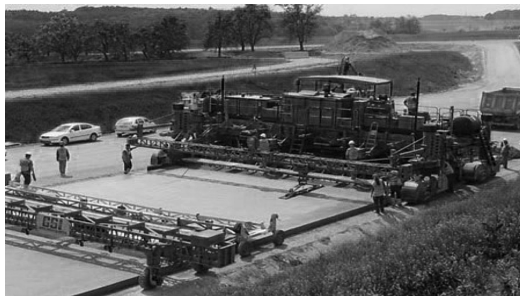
Строительство цементобетонного покрытия бетоноукладчиком со скользящими формами
